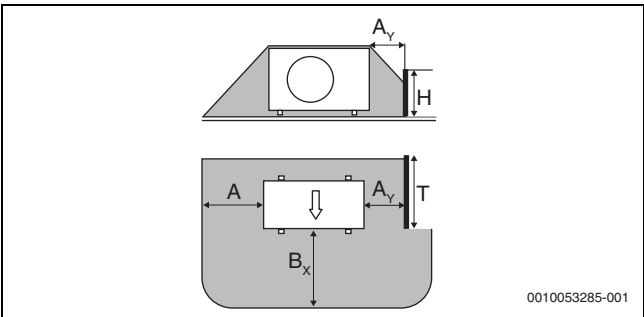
Schutzbereich mit Barriere rechts, bodenstehende Wärmepumpe
